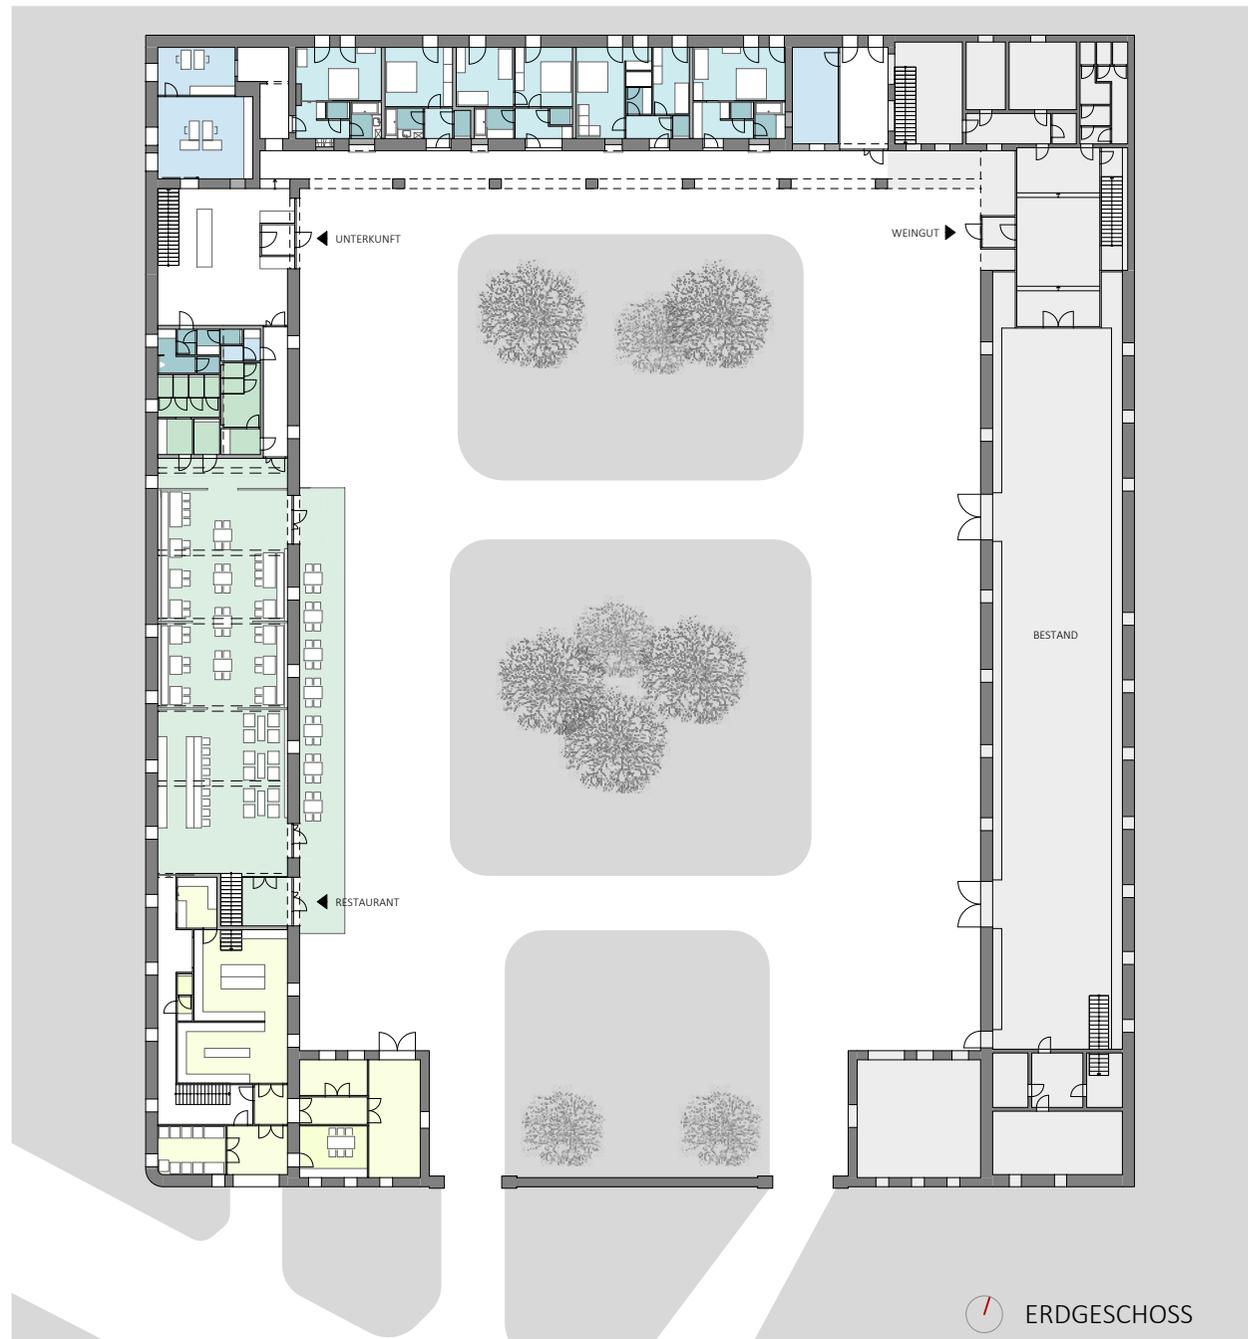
Erdgeschoss Schaflerhof, M 1:500
